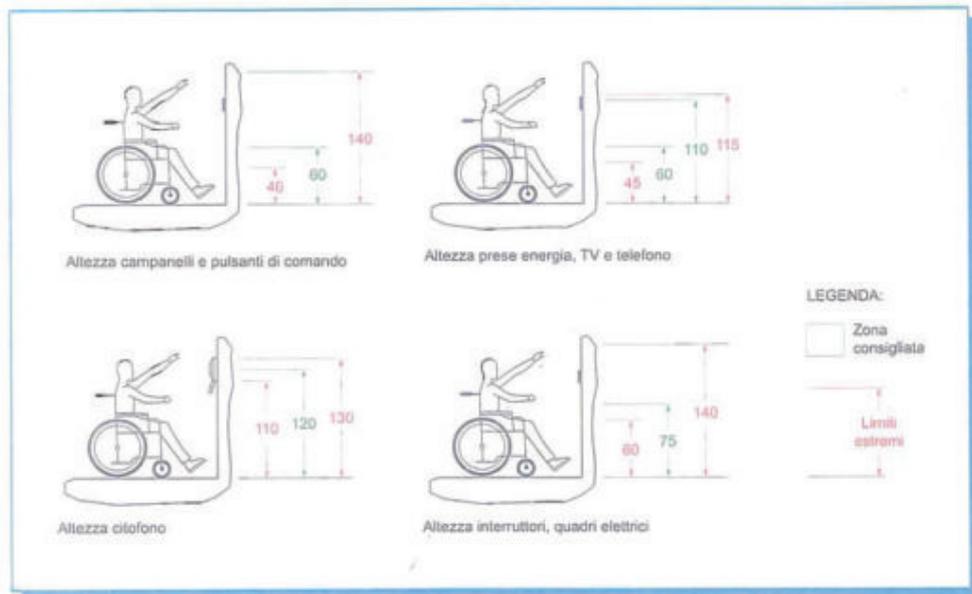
Disposizione delle apparecchiature elettriche ai fini dell'eliminazione delle barriere architettoniche (quote in centimetri).
